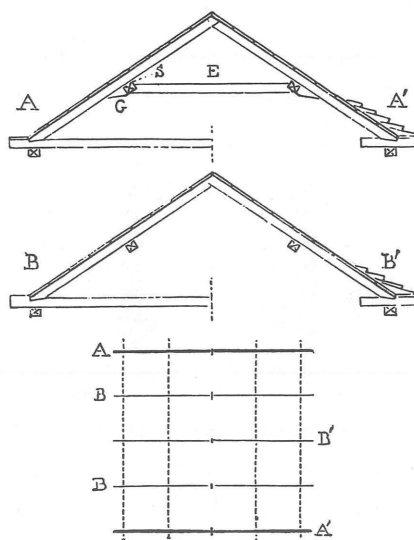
Armadura de pares con vigas inferiores (monasterio de Lavra, Atos)
